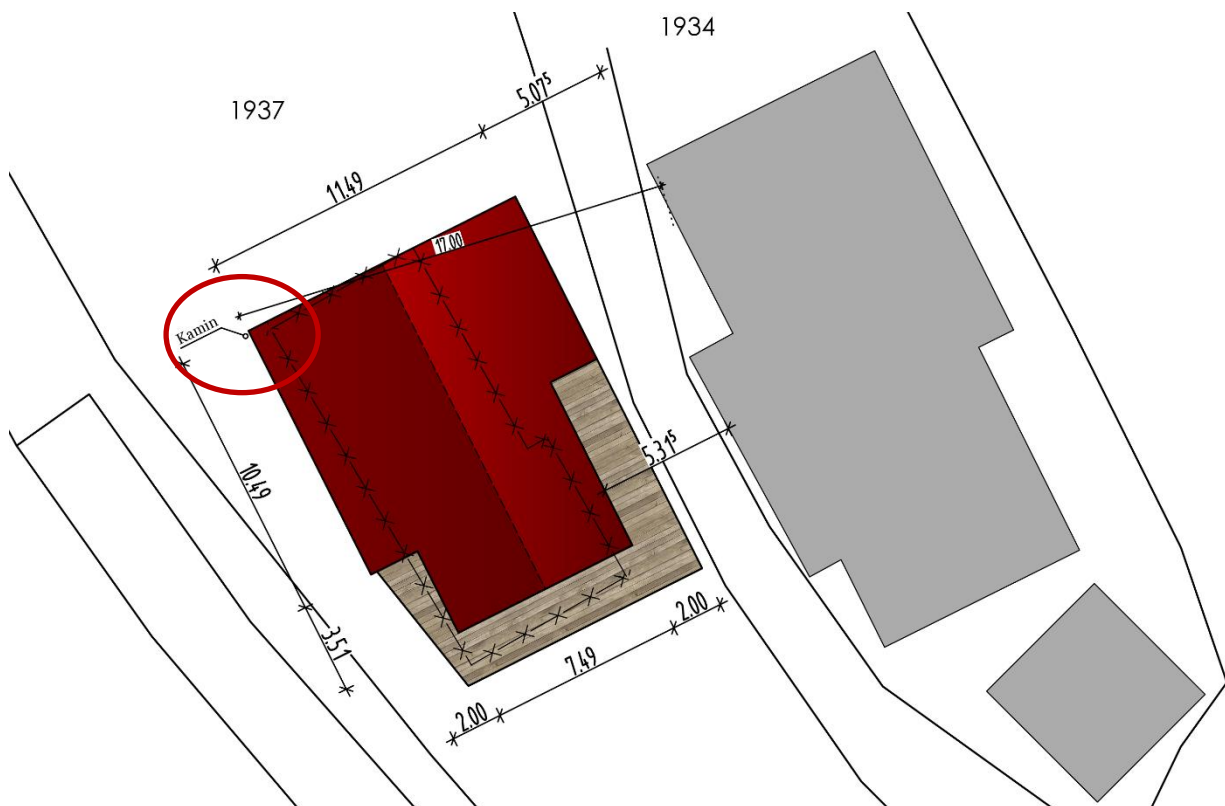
Lageplan des geplanten Gebäudes mit Kamin im nördlichen Bereich des Gebäudes (zur offenen Landschaft hin) (Planverfasser: Kellner Bauplanung)
